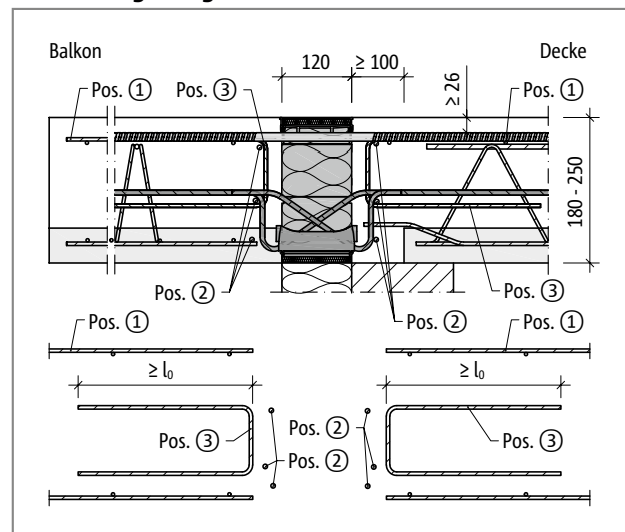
Schöck Isokorb® CXT Typ K-F-VV: Bauseitige Bewehrung bei Balkonplattendicke h = 180 - 250 mm
